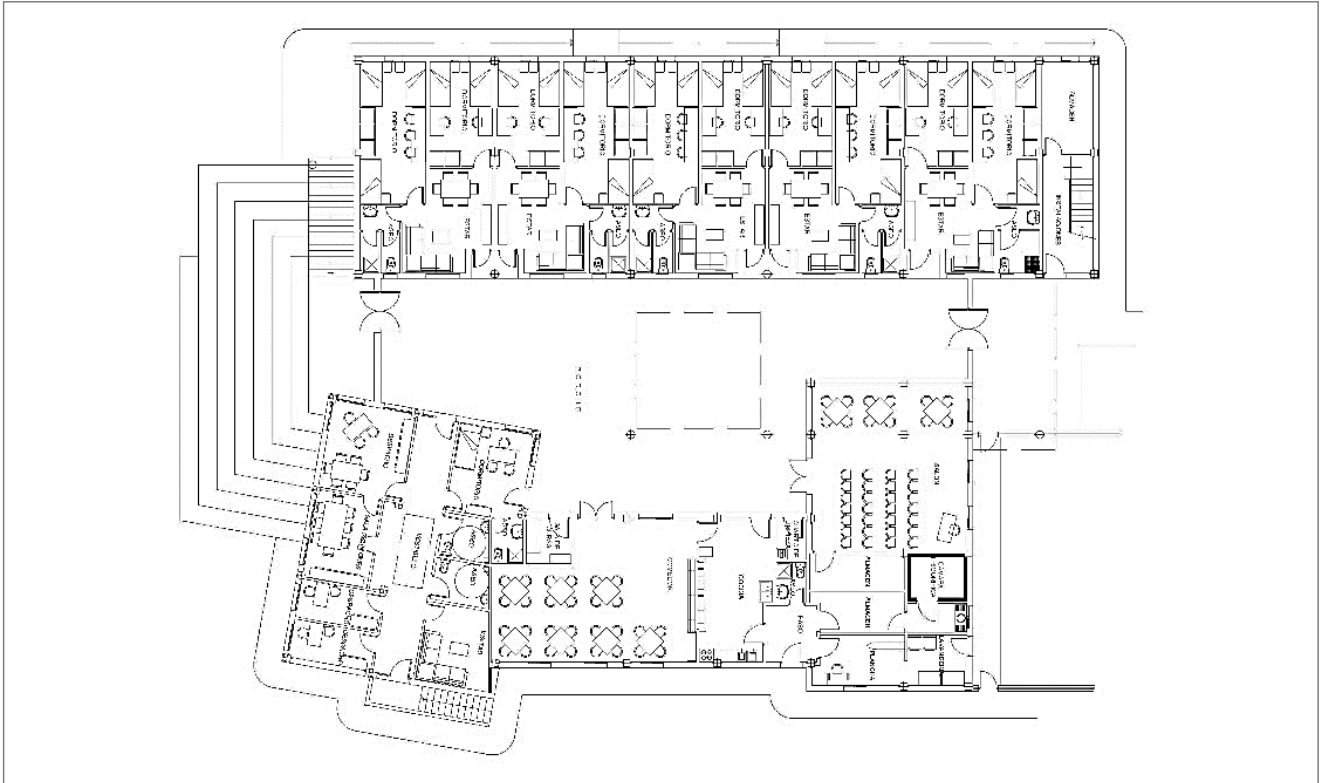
Centro residencial de protección al menor en Álora. Arquitecto Antonio Vargas Yáñez.
